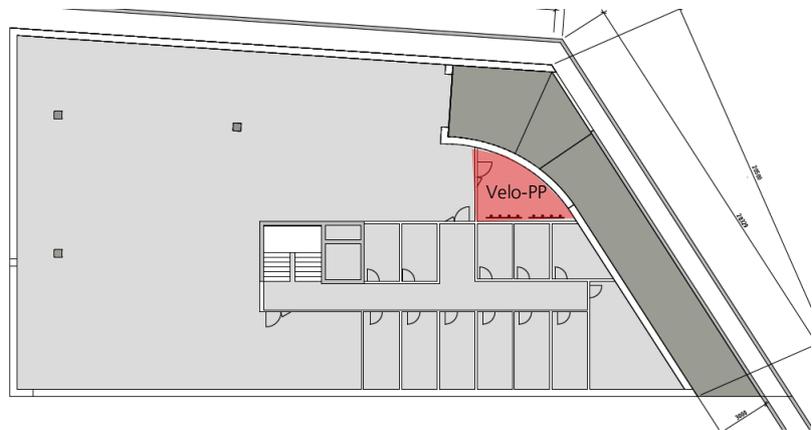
Plan Untergeschoss. Rote Fläche: Bereich Veloparkierung
